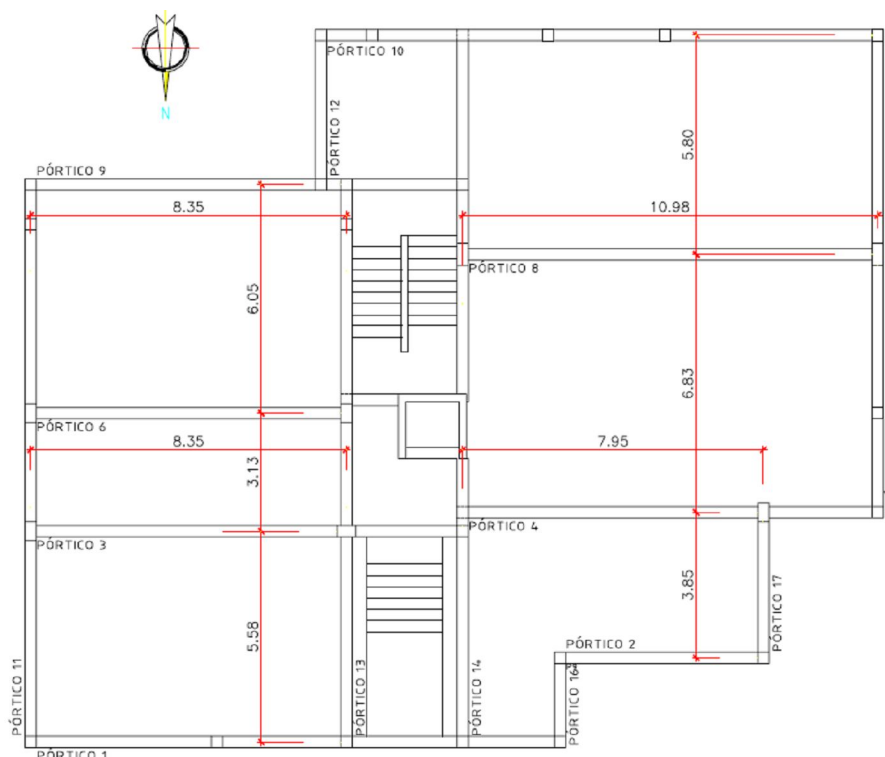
Sistema estrutural do pavimento (dimensões em metros).
